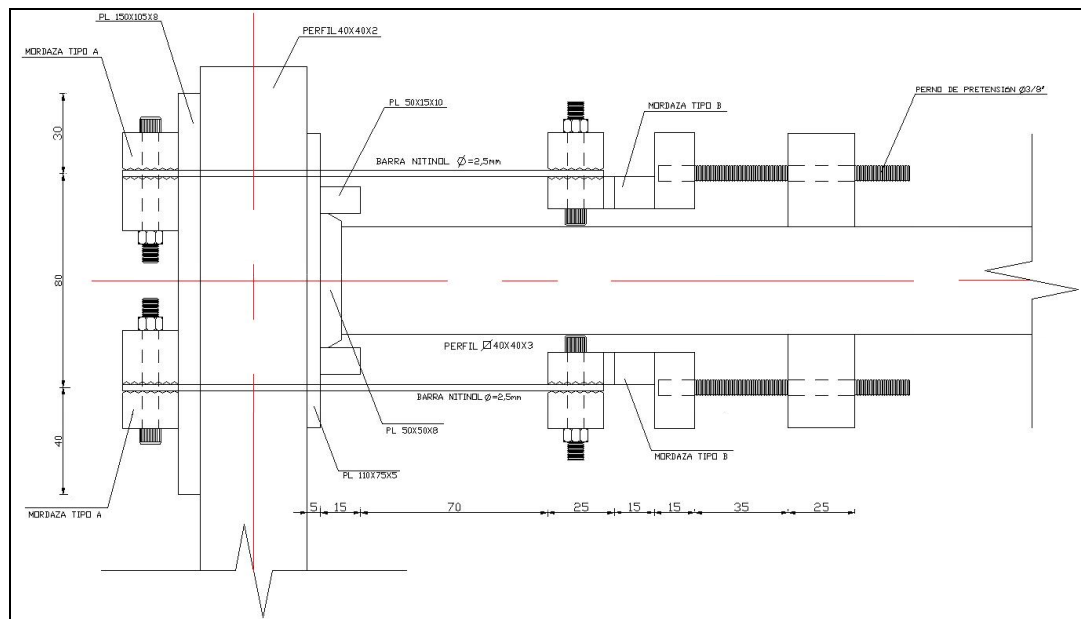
Detalle de la Conexión SMA. Vista en Lateral.
